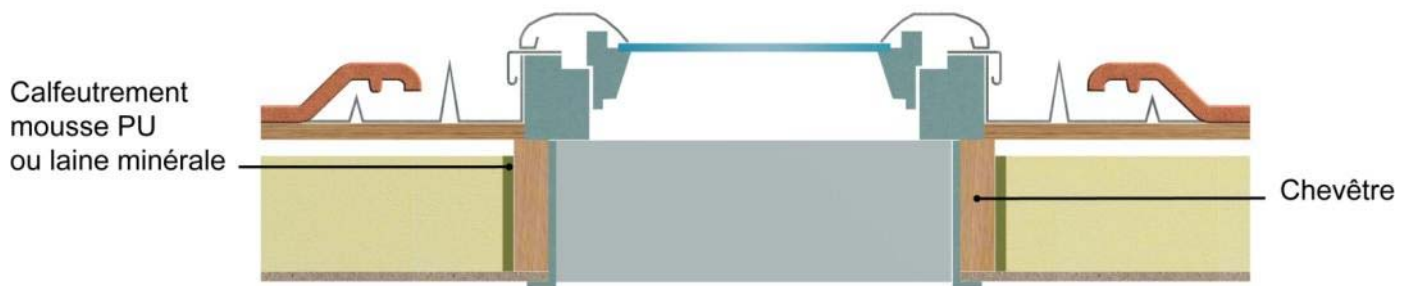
Principe de mise en œuvre de fenêtre de toit – Coupe horizontale
